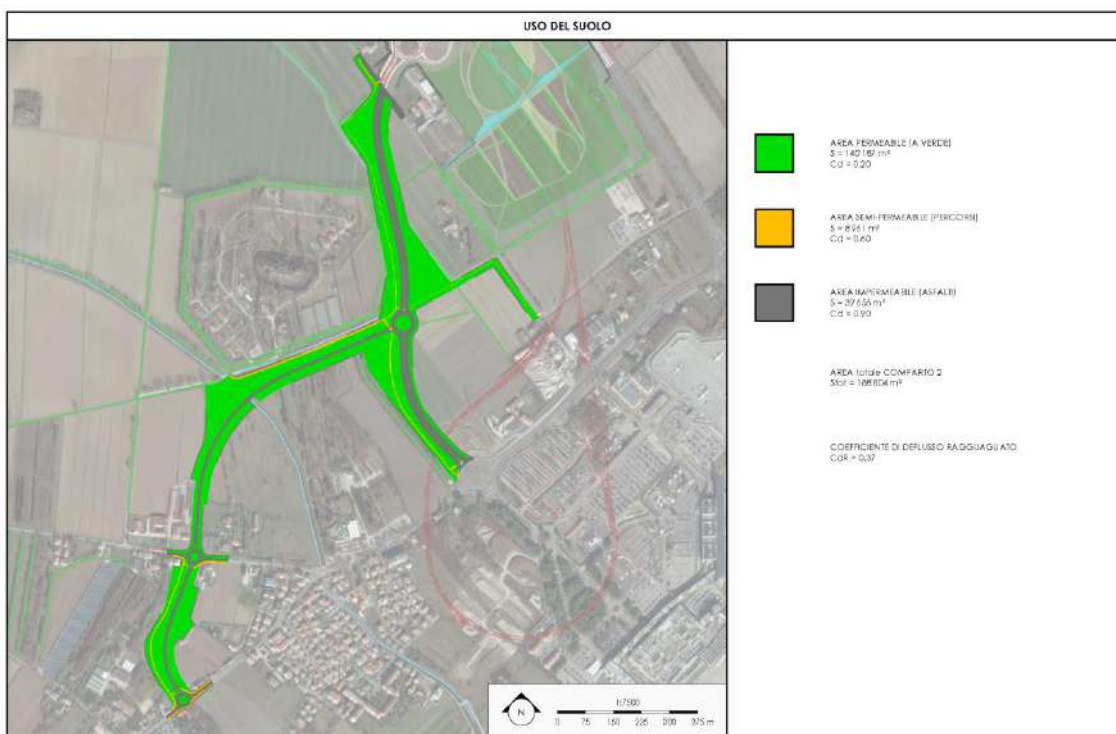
caratteristiche uso del suolo - stato di riforma - planimetria permeabilità delle superfici viabilità di collegamento
